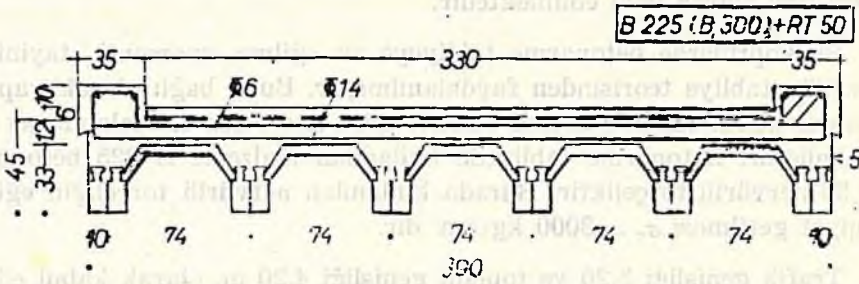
Hazır betonarme kirişli köprü enkesiti
